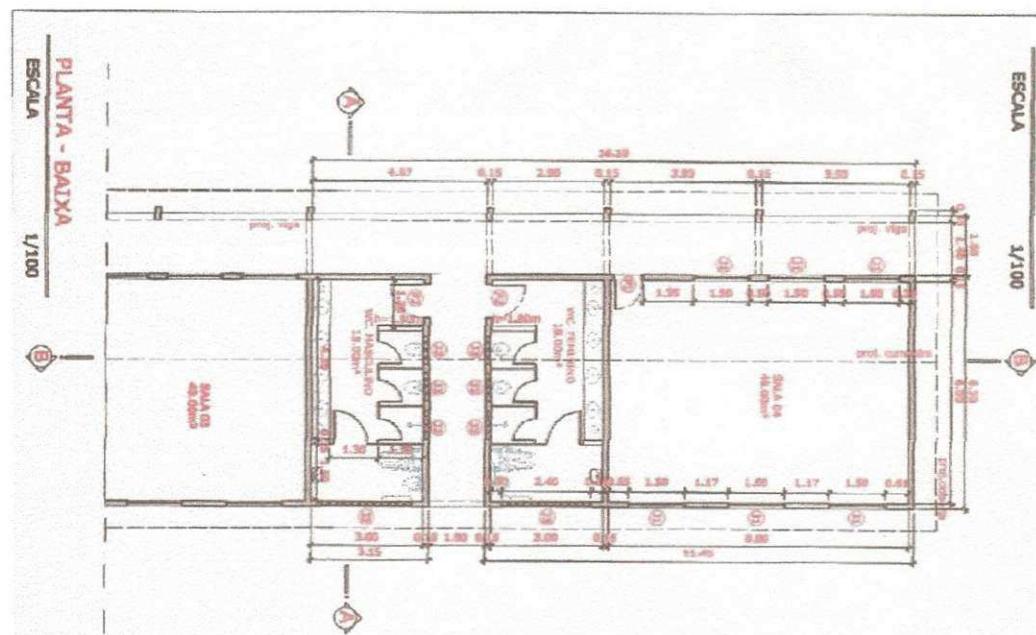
Planta Baixa dos Banheiros e sala de aula 1.
